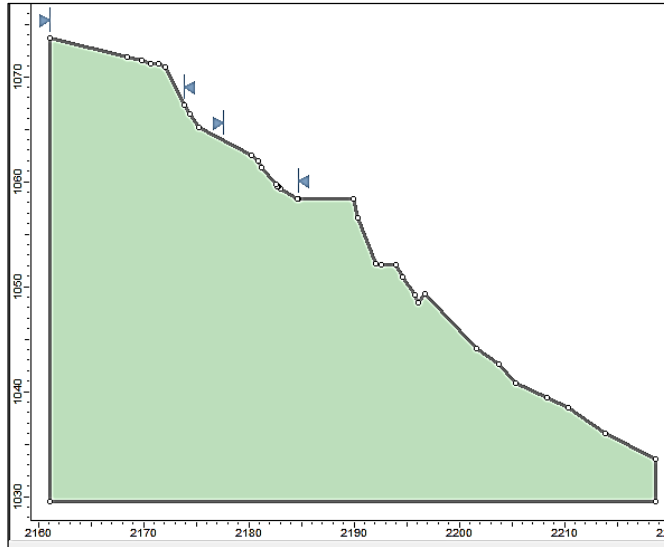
Sección transversal corte B-B, importado del CivilCAD 3D
